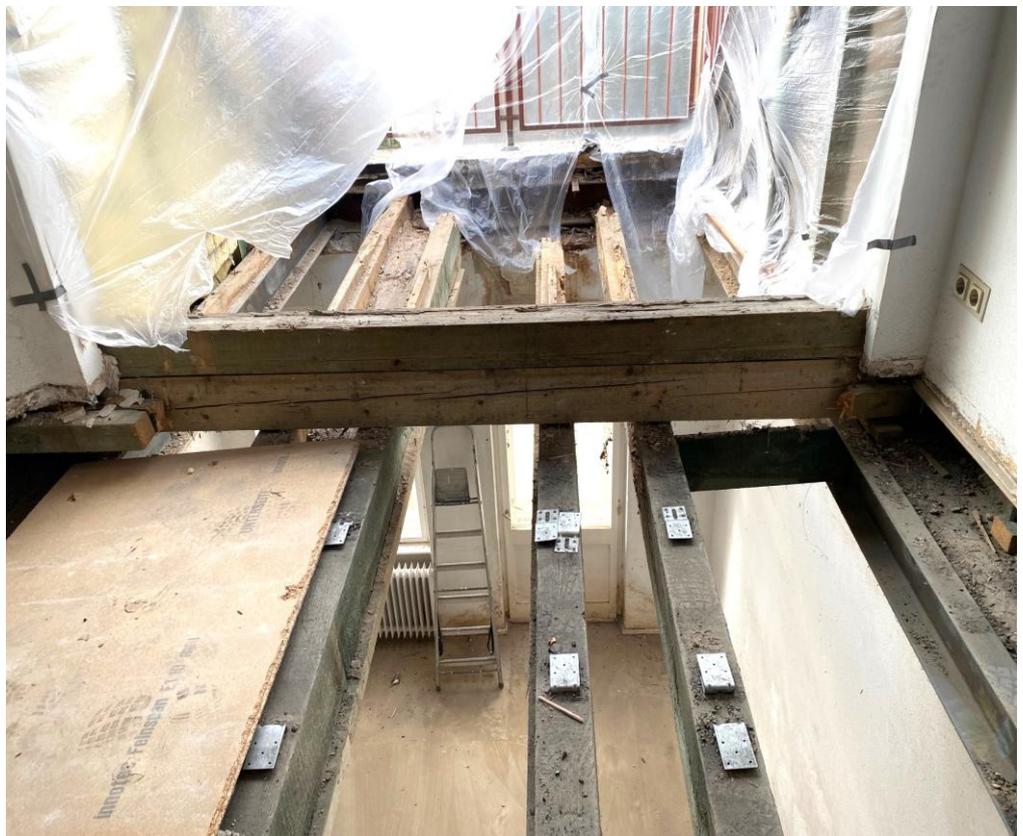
OT 2024-11-05 – Ansicht Balkenlage nach weiterer Freilegung - Terrasse
